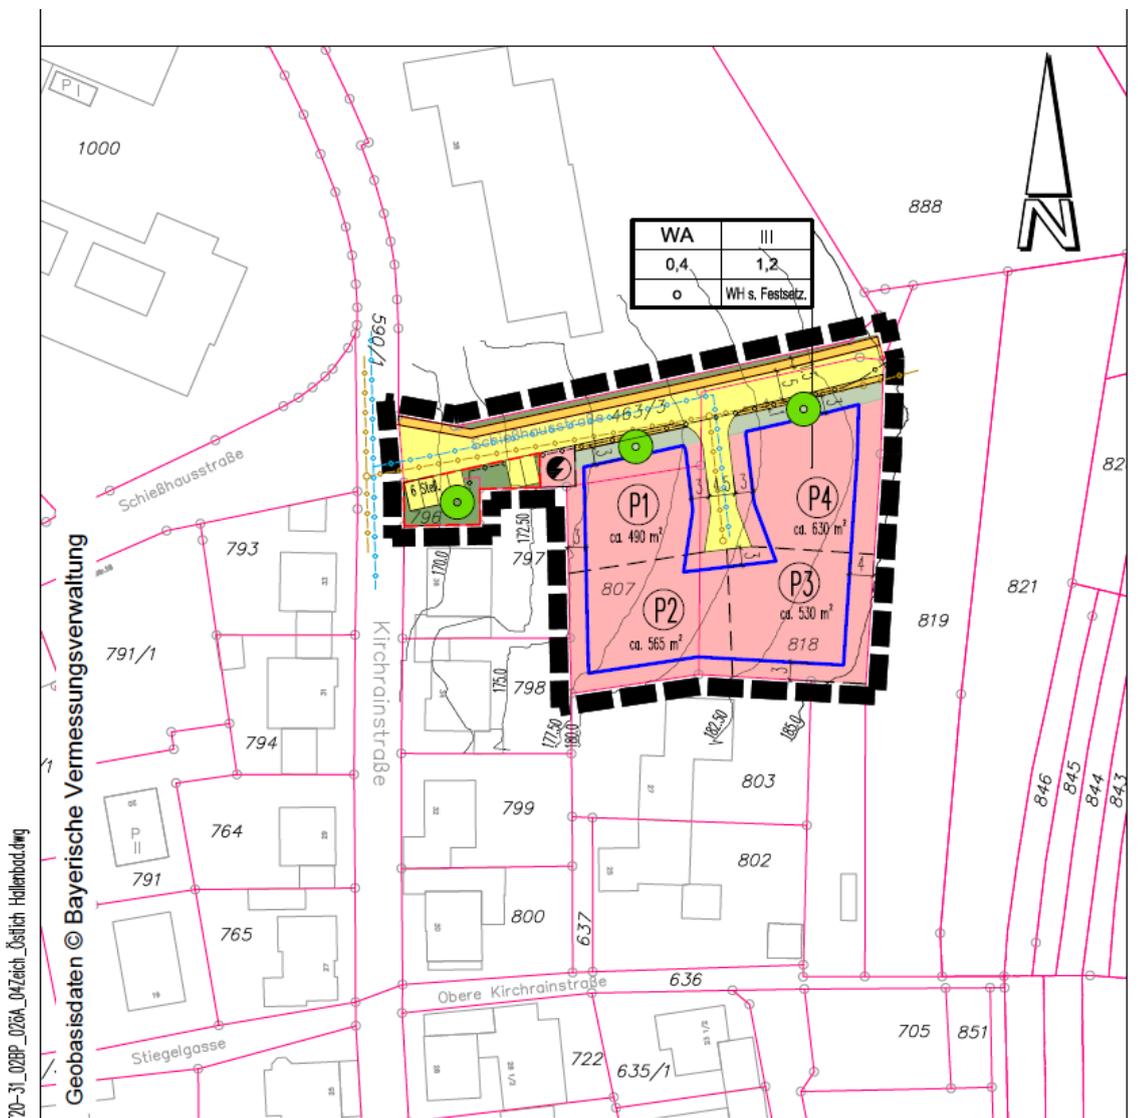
Entwurf des Bebauungsplans mit Stand Dezember 2020 (Johann und Eck Architekten und Ingenieure)
